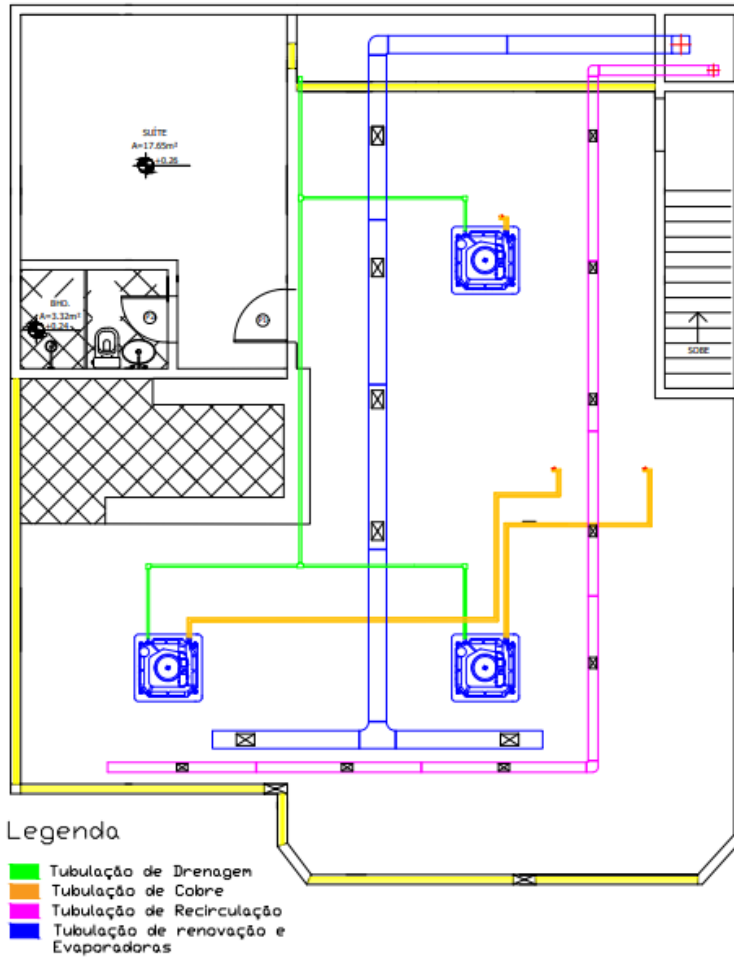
Planta da Edificação com Tubulação e Evaporadoras
